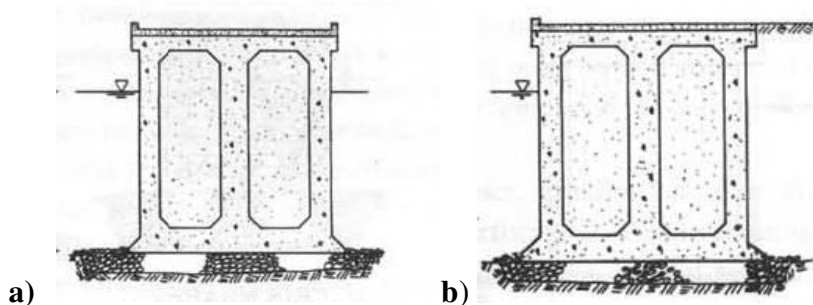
a) Perfil transversal e b) perfil longitudinal de um *jetty* em caixotões (Gaythwaite, 2004)
